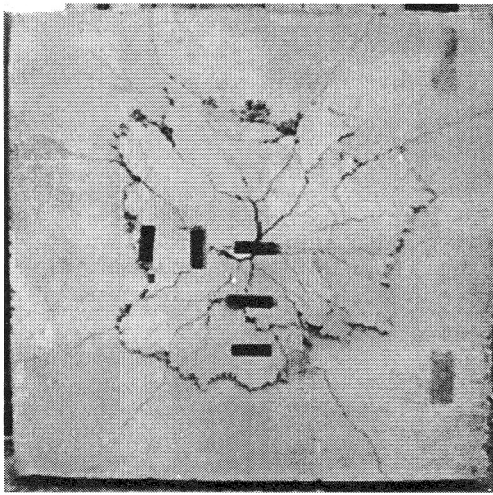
床版のひび割れ状況(20-1/2As-1)
